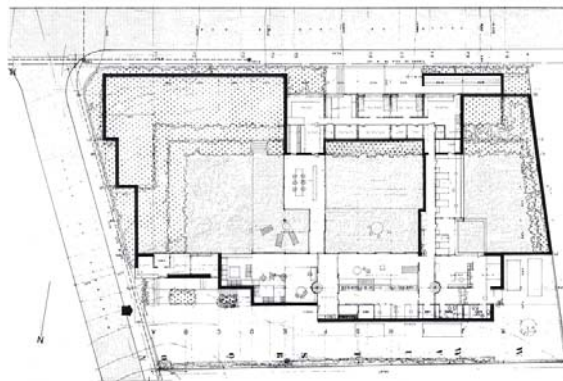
Casa Huarte. Planta baja, publicada en *Arquitectura* 94, octubre 1966
